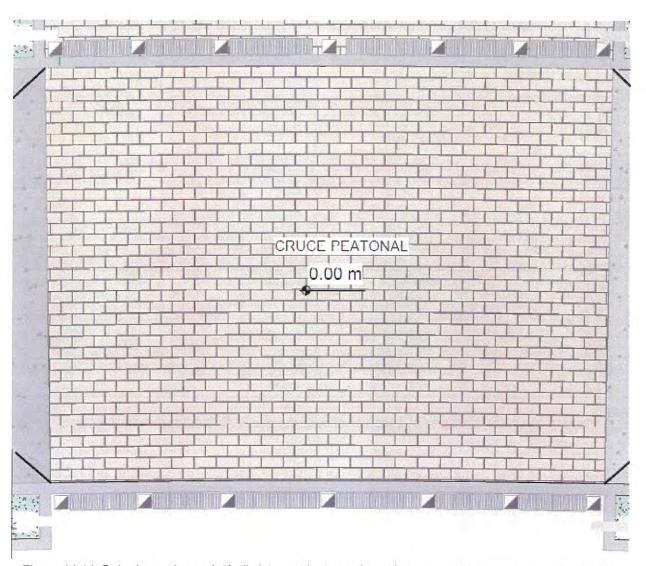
Bolardos y piso podotáctil vista en planta en desembarco en el Estacionamiento Ecológico.
